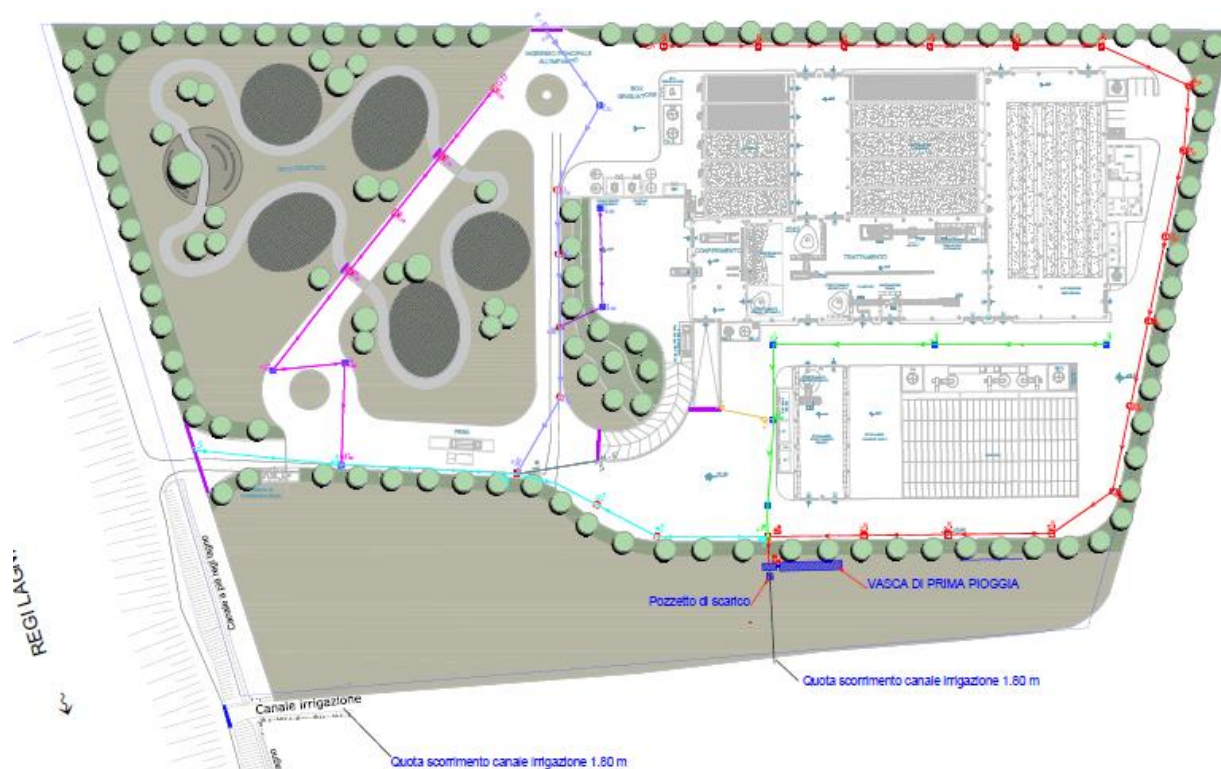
PLANIMETRIA ACQUE METEORICHE DAI PIAZZALI
